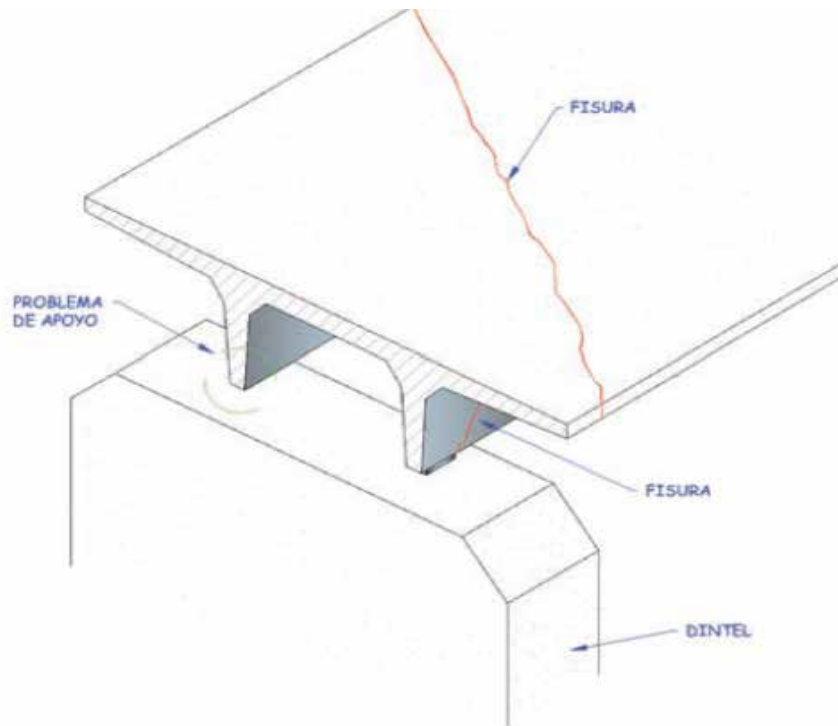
Fisuras debido a un descalce en un apoyo.
